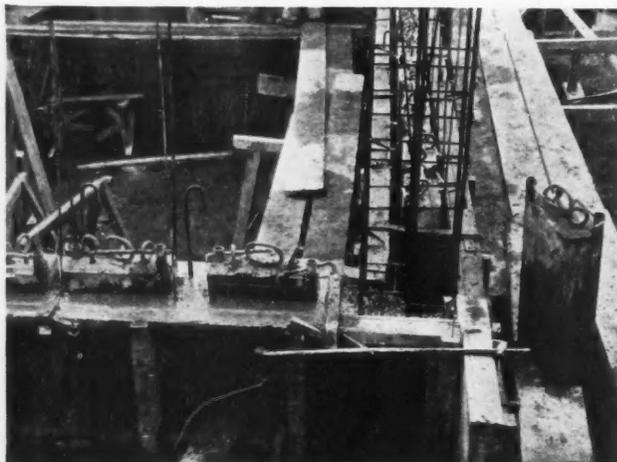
Fig. B. Construction de murs en béton banché par coffrage montant et caissons métalliques intérieurs.
